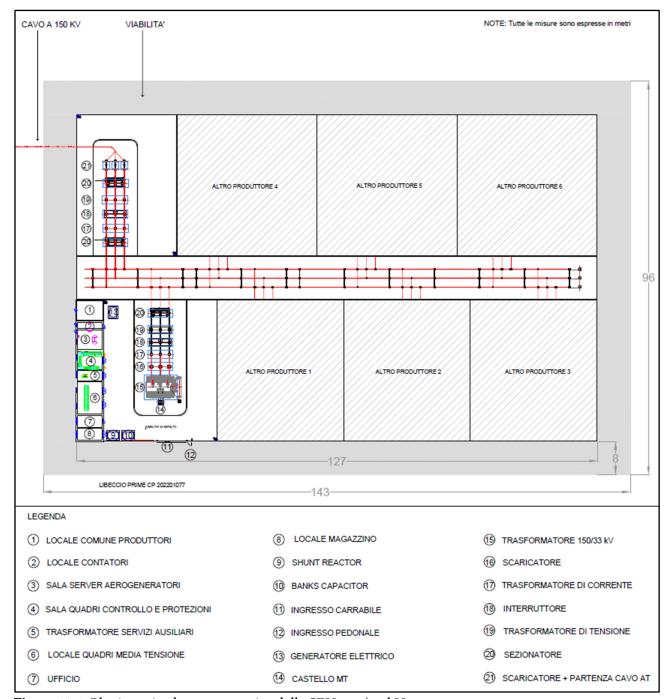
Planimetria elettromeccanica della SEU 150/33 kV
